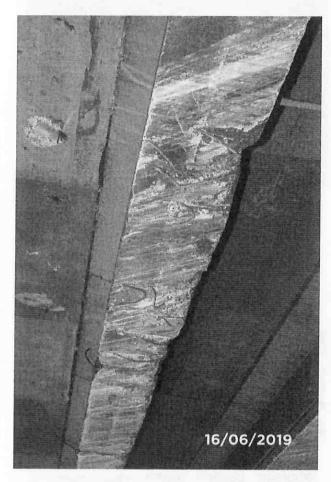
Vista da face inferior do tabuleiro, sentido centro. Vigas com desplacamento de concreto, infiltrações, armaduras expostas e rompidas.
